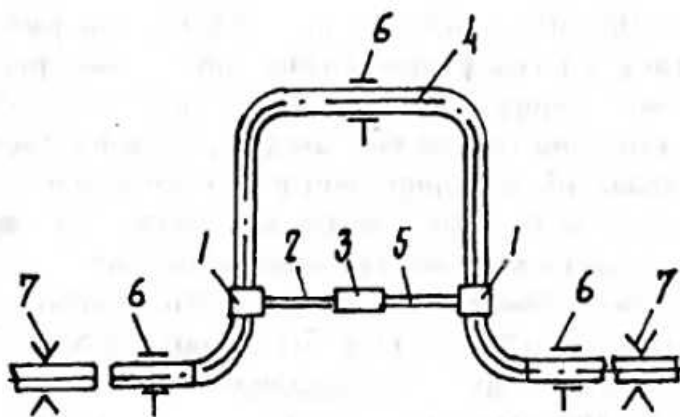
Схема розтягування П-подібного компенсатора: 1 - розбірний хомут; 2, 5 - стержні з правою і лівою різью; 3 - фаркопф; 4 - компенсатор; 6- рухомі опори; 7 - нерухомі опори
